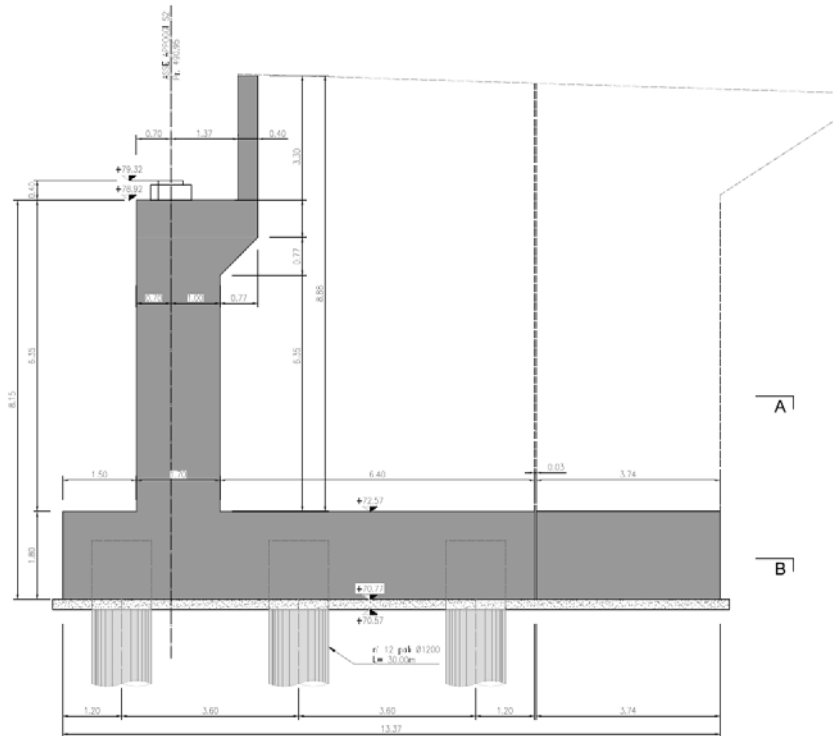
Sezione trasversale e prospettiva spalla S2
